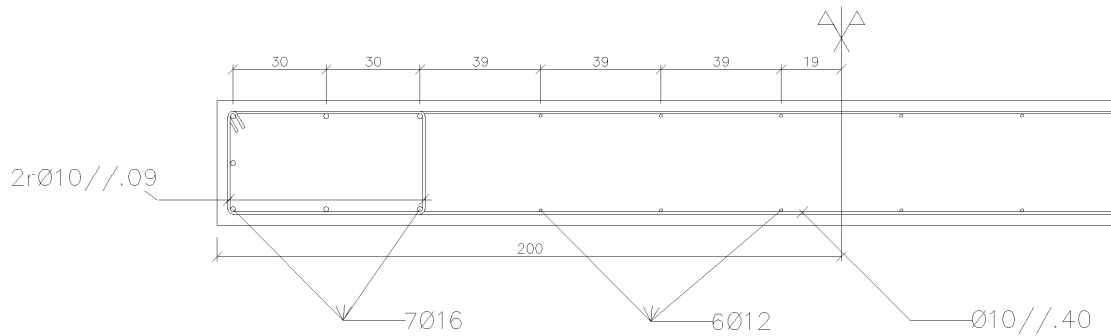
Solução de armadura nas paredes Pa2, Pa4, Pa5, Pa6, Pa7 e Pa8 (metade da rigidez) [cm]
